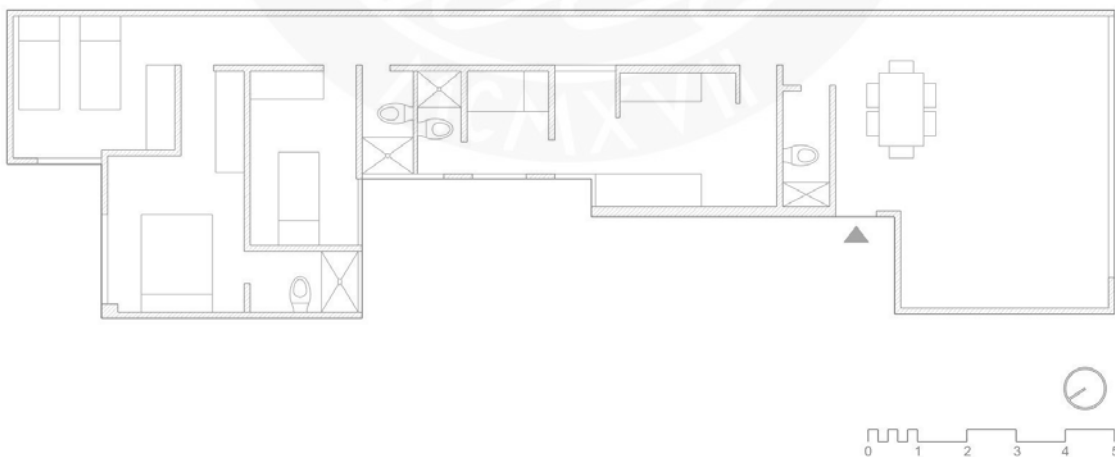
Planta de un departamento de tres dormitorios del edificio Calle 20, hecho por la autora.
